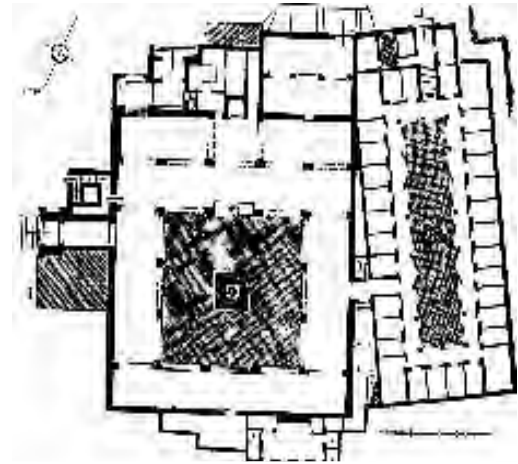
مسقط أفقى لجامع المدرسة البوعنانية
